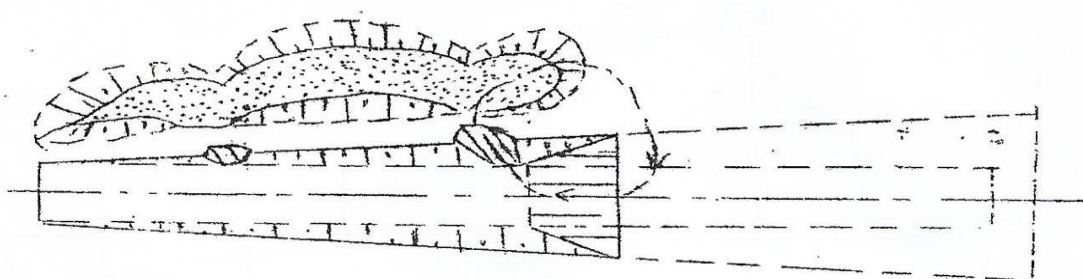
Excavation d'une tranchée par scraper automoteur
